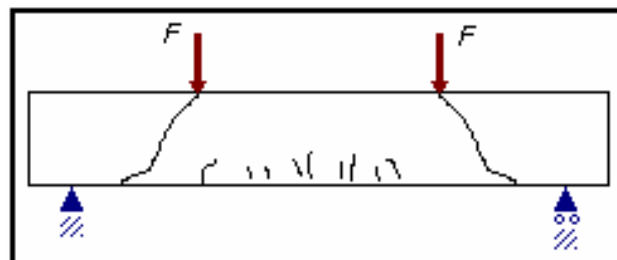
Fissuras de cortante-flexão (O'BRIEN &amp; DIXON, 1994)
